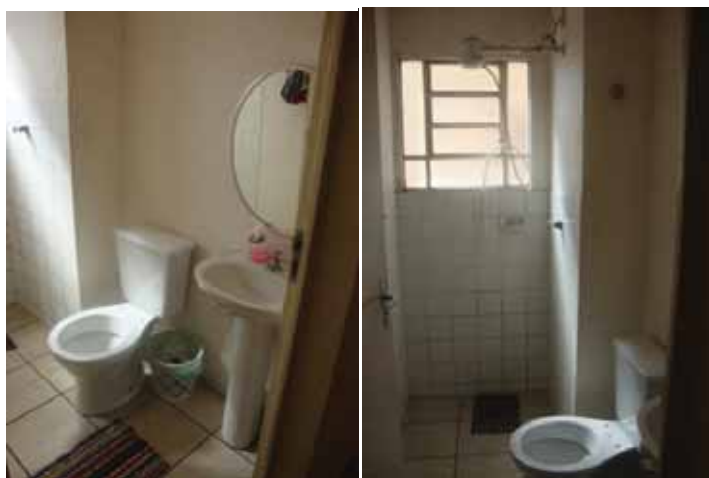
Banheiro - “Conjunto Habitacional São José do Rio Preto K”
